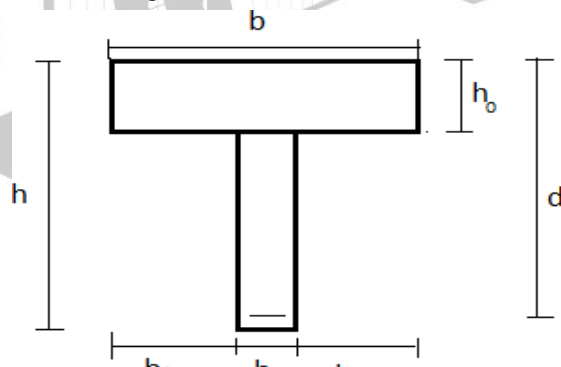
Section de calcul de la poutrelle après coulage de la dalle de compression
